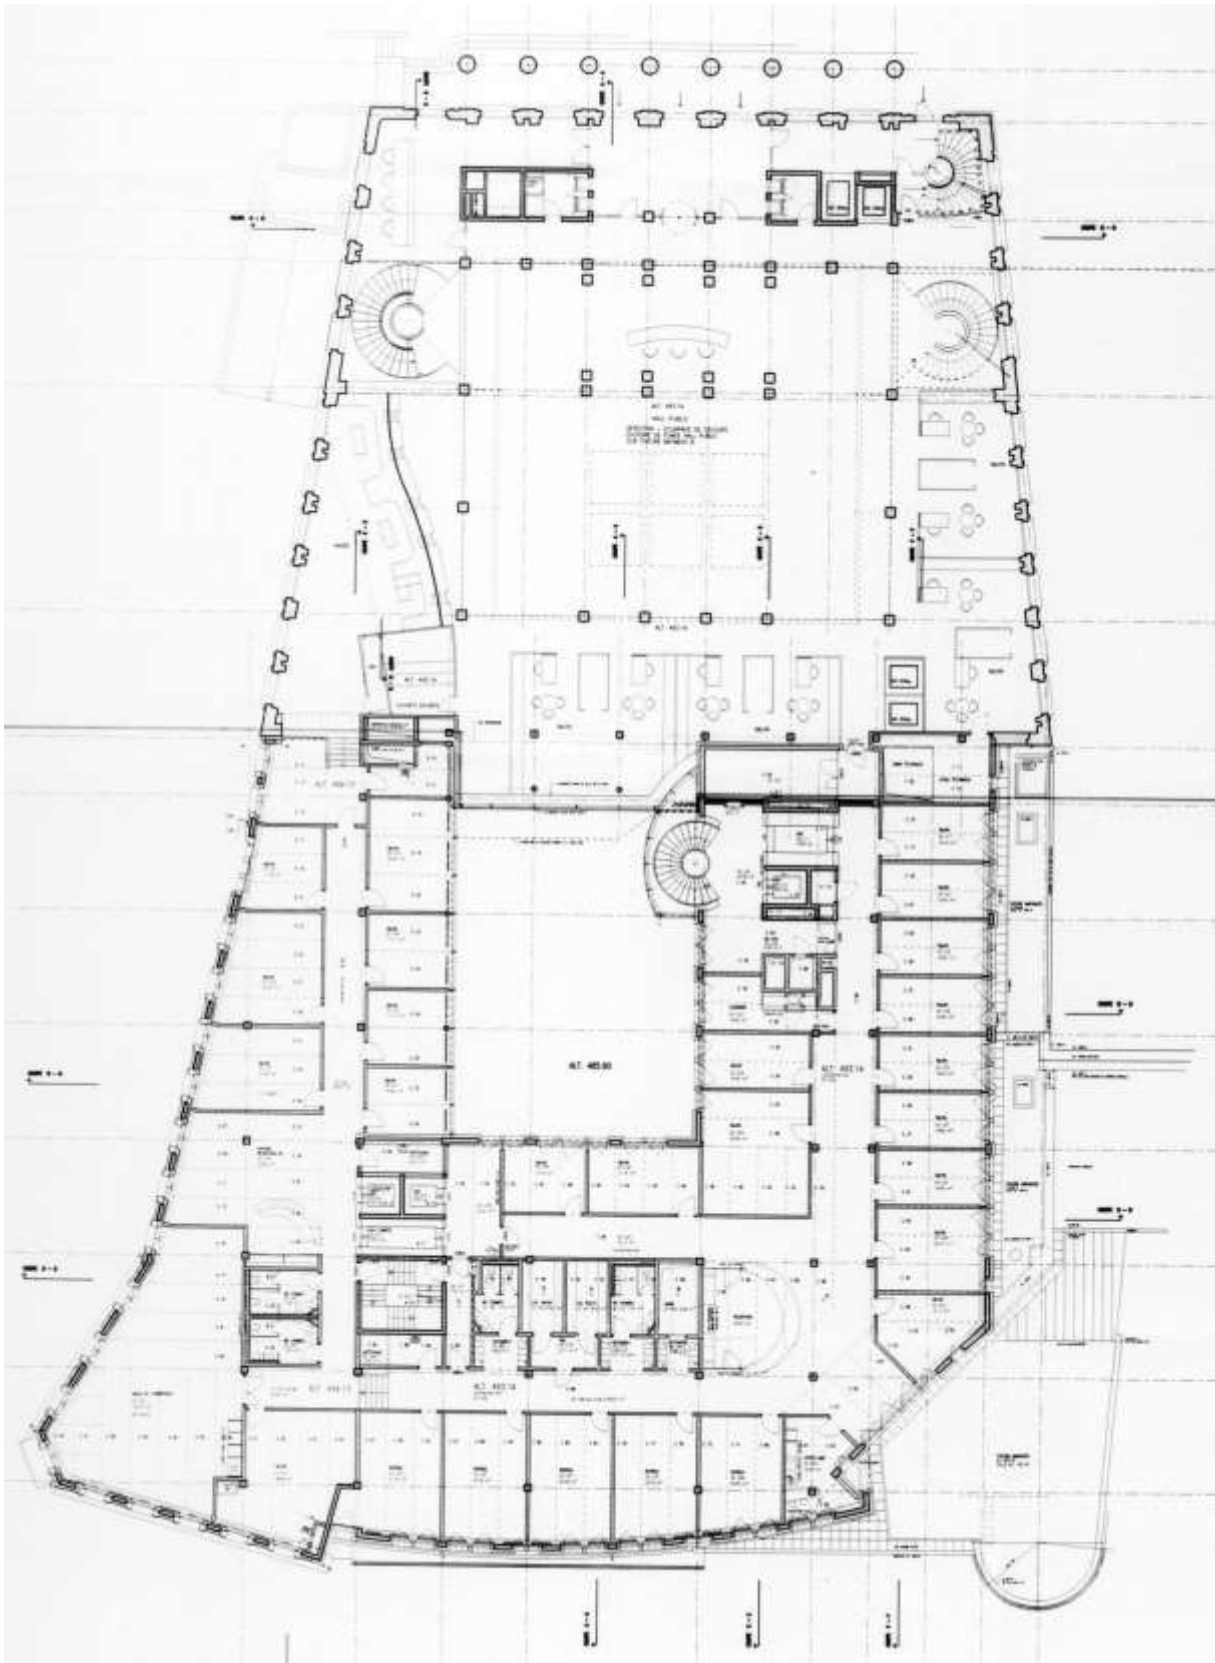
Plan du rez-de-chaussée, au niveau de la place Saint-François, 18.9.1996, Jean-Philippe Poletti architecte (AVL, mises à l'enquête publique, 374/F352).
